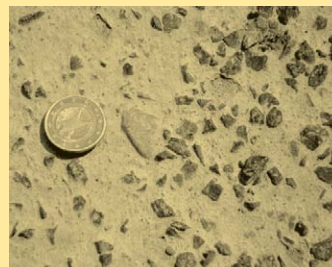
Betondecke mit hochwertiger Waschbetonstruktur
